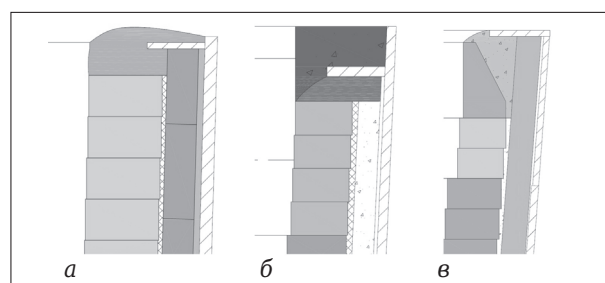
Схема футеровки под опорным кольцом сталеразливочного ковша: а — набивка массой или заливка бетоном сегментов кольца; б — подбивка массой под кольцо и заливка огнеупорным бетоном; в — установка обратного клиновидного кирпича пятового формата
